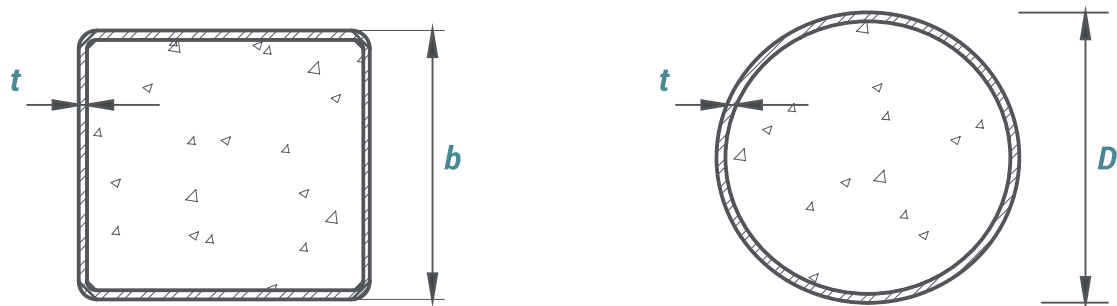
Columnas compuestas acero-concreto perfiles rellenos de concreto.
